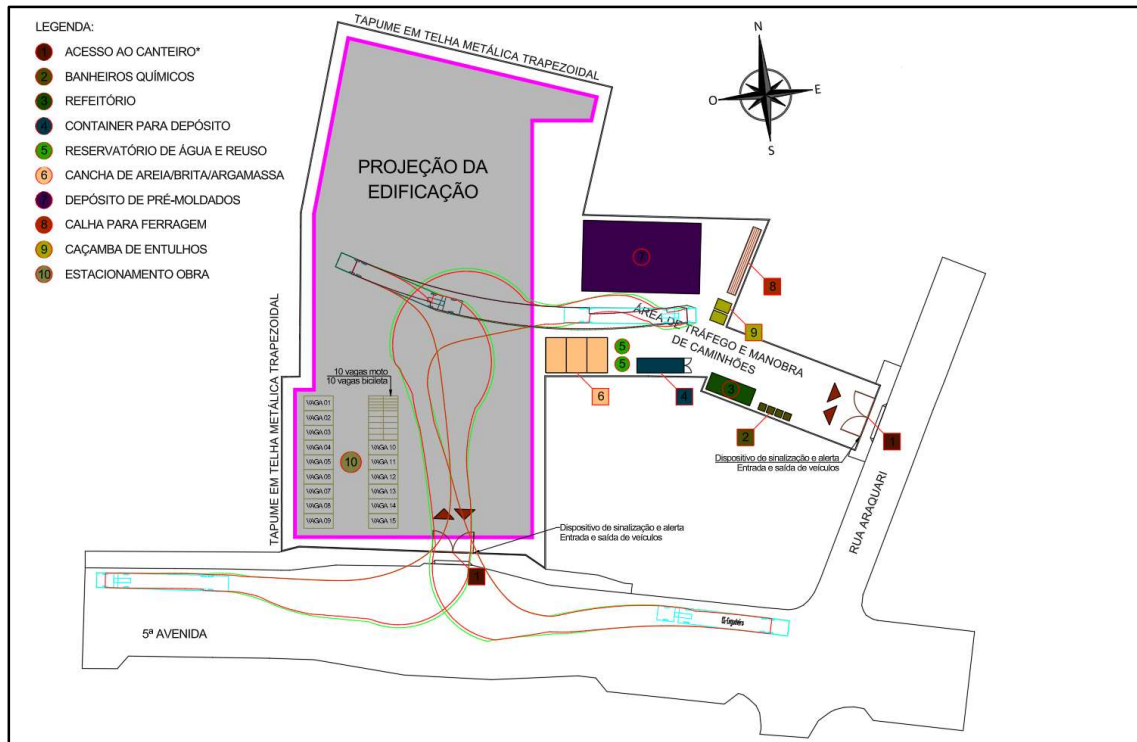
Canteiro de obras projetado – Primeira Fase.
